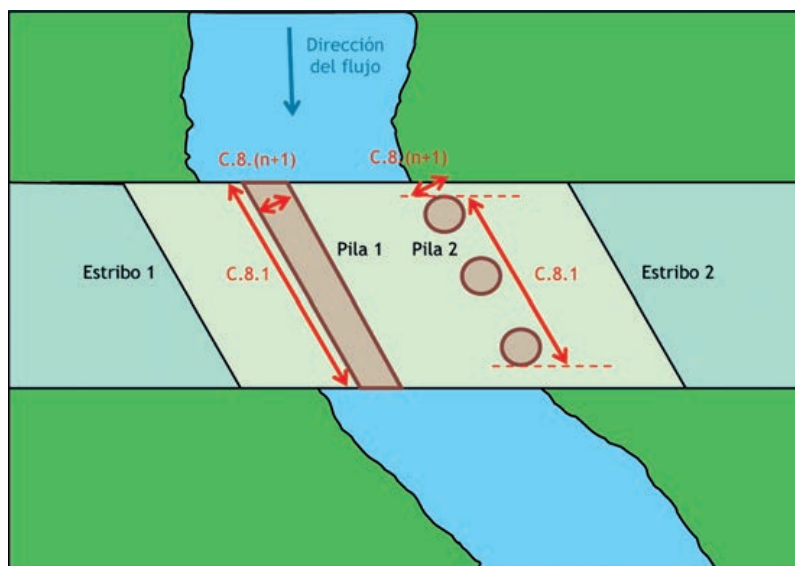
LONGITUD Y ANCHURA DEL PARAMENTO DE LAS PILAS DE UN PUENTE.
